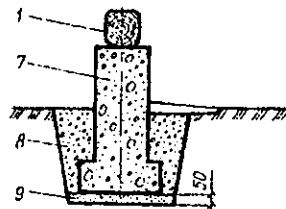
Деревянный ростверк на столбчатом бетонном фундаменте для деревянных построек
